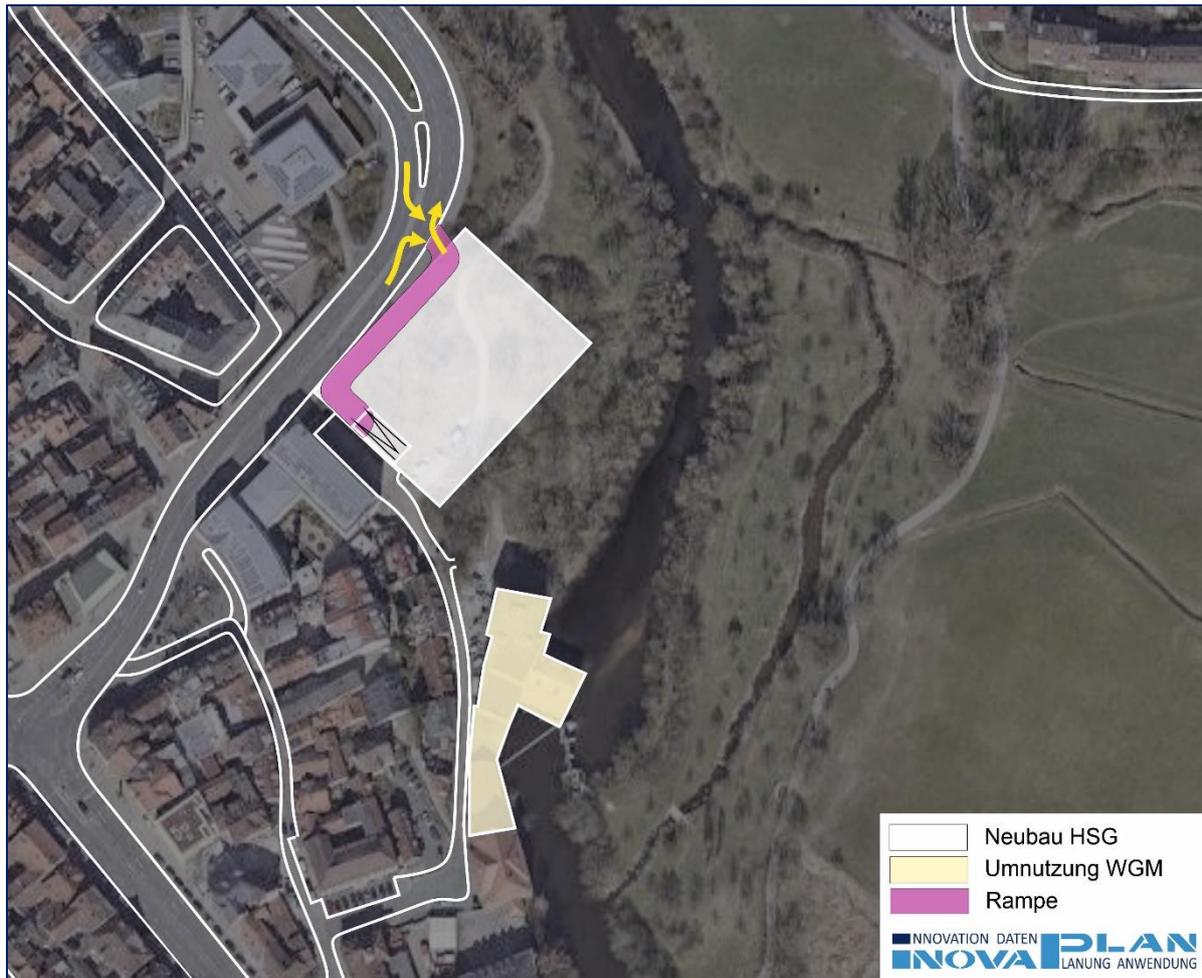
Planung Rampe Henri-Dunant-Straße
